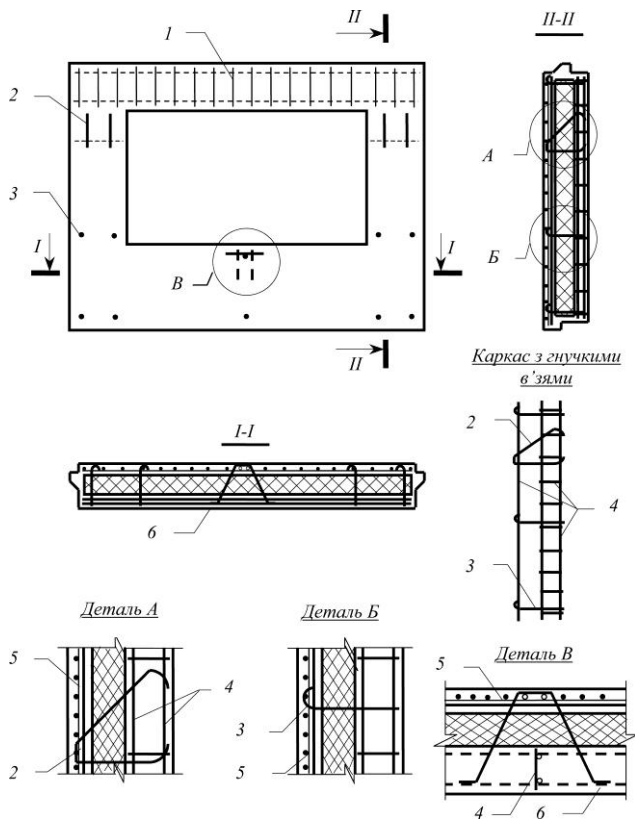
Схема конструктивного двостороннього армування внутрішнього шару тришарових панелей з гнучкими в'язями, що рекомендовані для застосування в несучих стінах житлових будівель висотою 12 і більше поверхів: 1 – каркас перемички; 2 – підвіска; 3 – розпірка; 4 – каркас внутрішнього шару панелі; 5 – арматурна сітка зовнішнього шару панелі; 6 – косяк.
